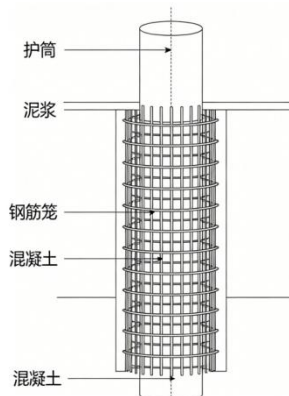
桥梁钻孔灌注桩桩基构造及施工示意图
